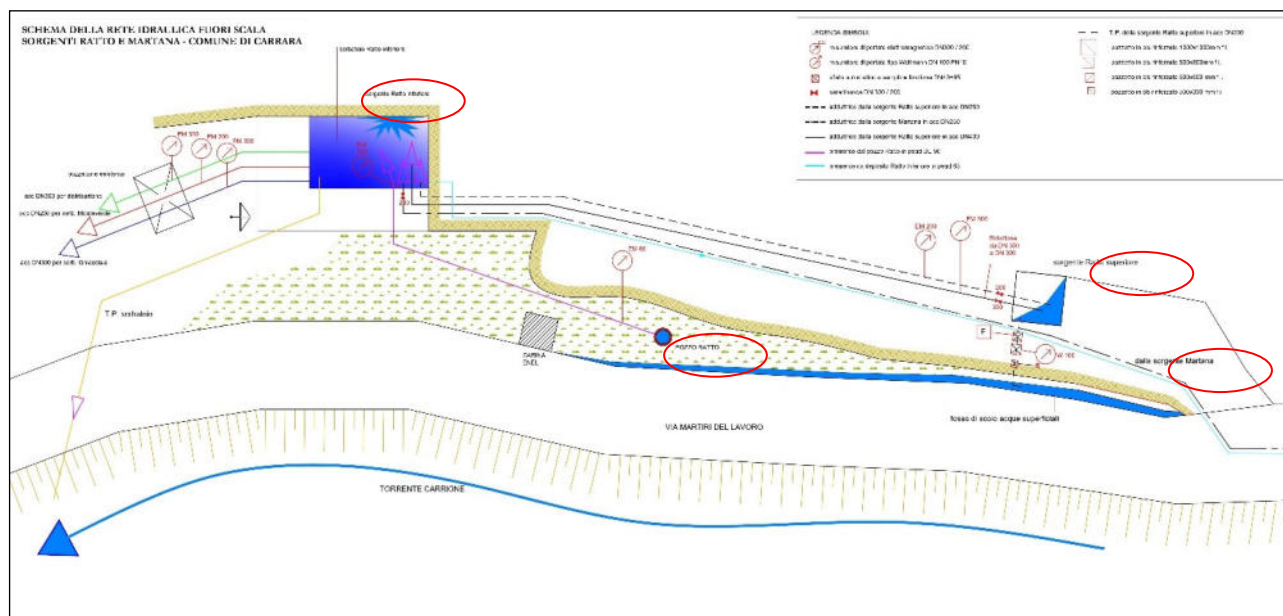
Planimetria dettagliata delle sorgenti Ratto e Martana.
